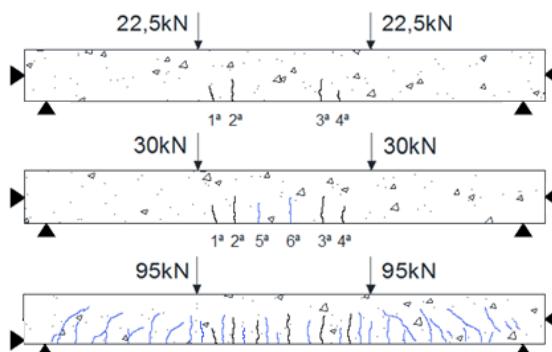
Formação e evolução das fissuras da Viga1old.
